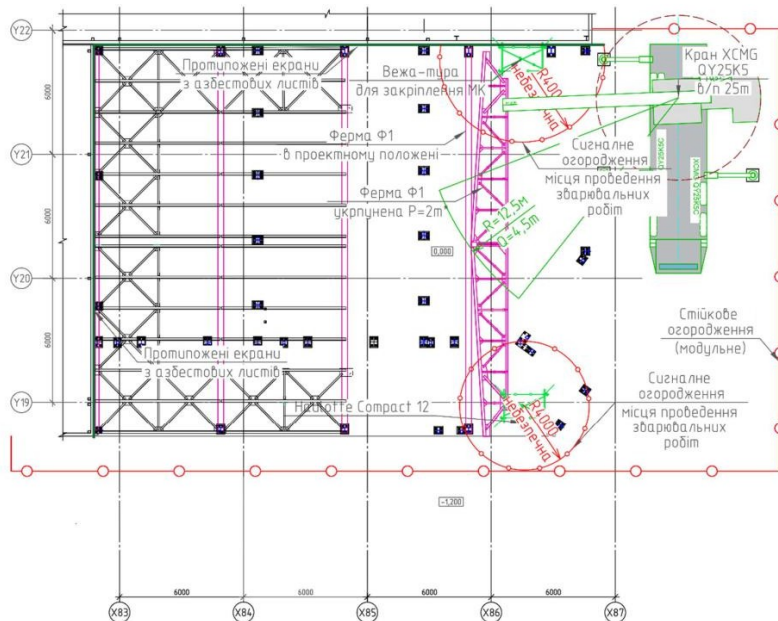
Схема монтажу ферми Ф1 в осях Y22-Y19, X85-X86.
